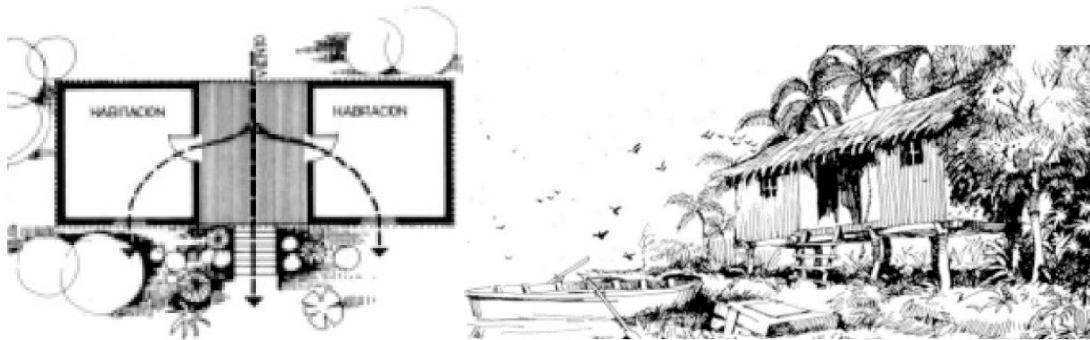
Planimetría e ilustración de vivienda isleña. Carli 1980
